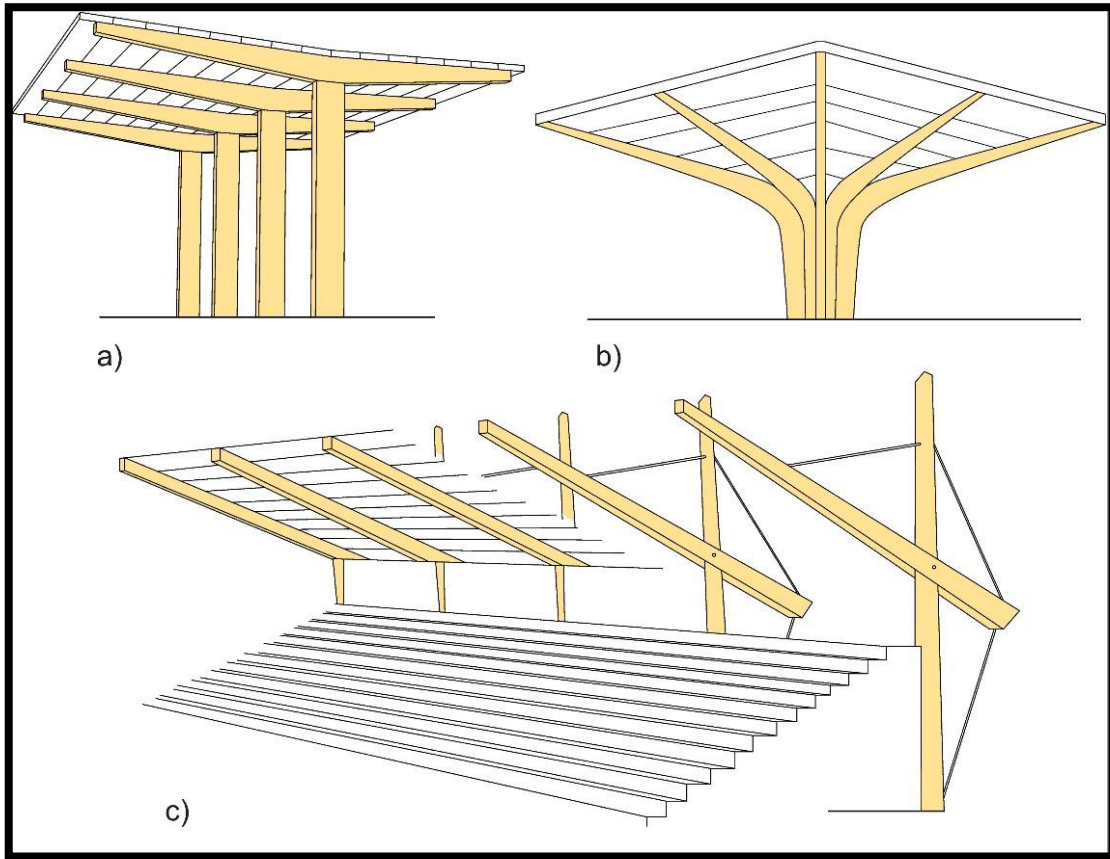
Modélisation 3d de la structure en cantilevers. . (a,b) Toiture isolée avec poteaux encastrés, (c)tribune avec cantilevers a l'arrière
